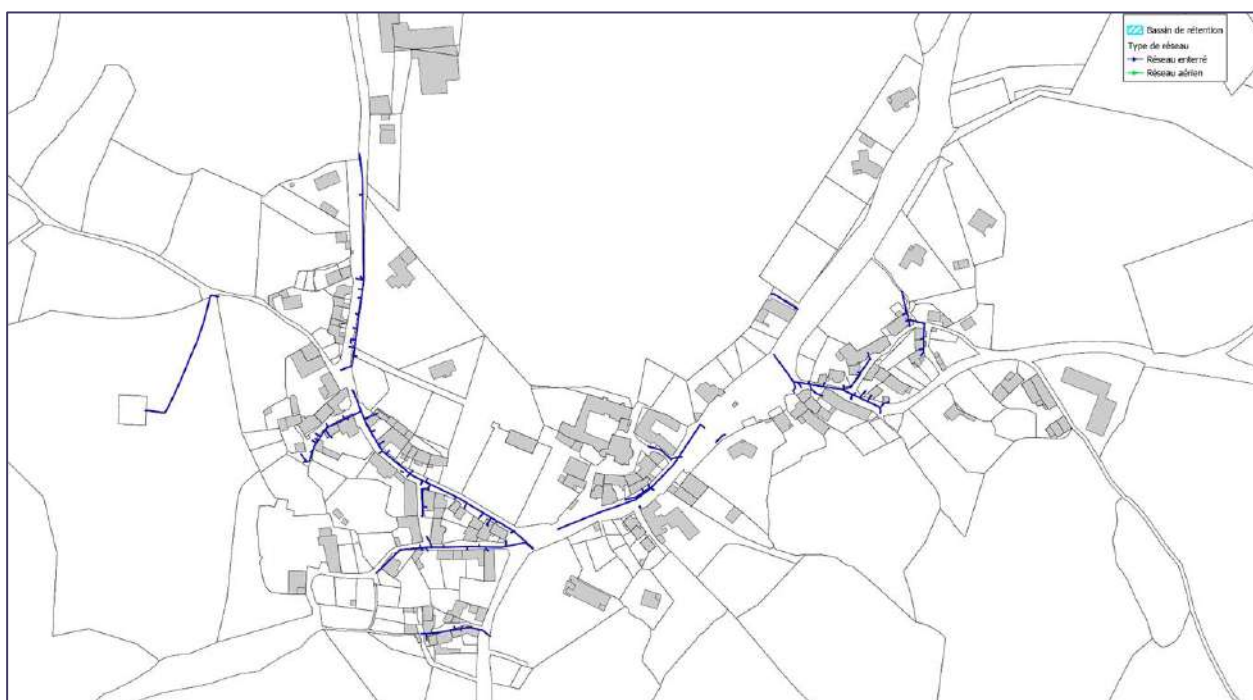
Plan du réseau pluvial de Lavernhe – 1.3 km (plan SIG transmis par la commune)
